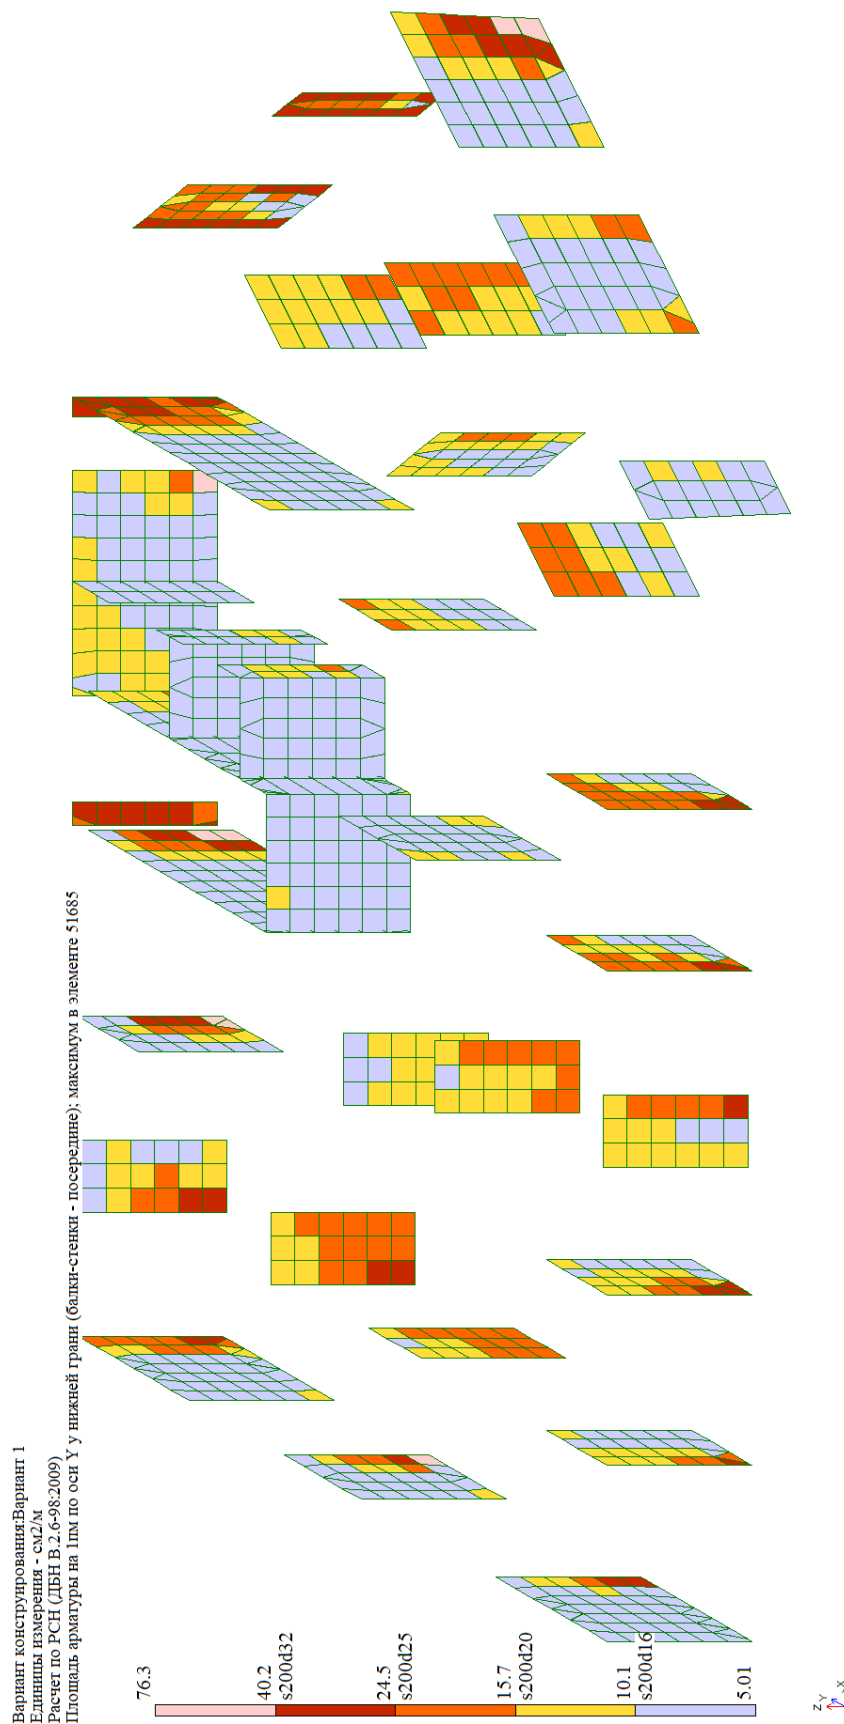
Арматура нижня зона, в стінах та пілонах 1-го поверху
